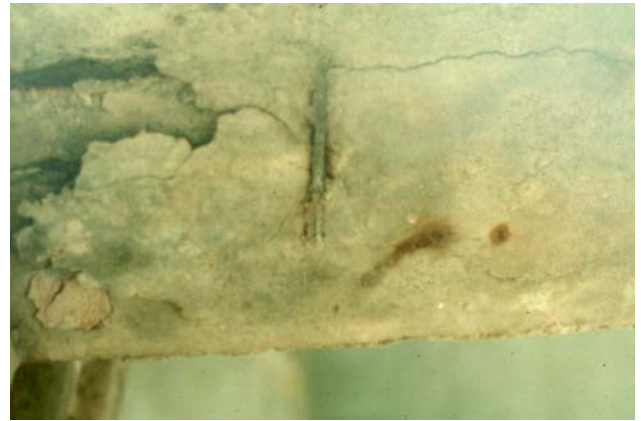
Fissuração decorrente da oxidação da armadura, devido ao recobrimento insuficiente.
